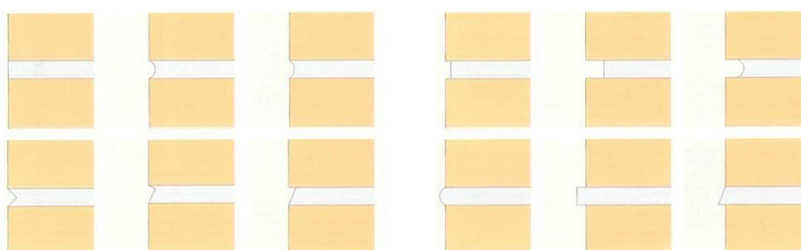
Tipos de juntas em tijolo com face à vista [48]
